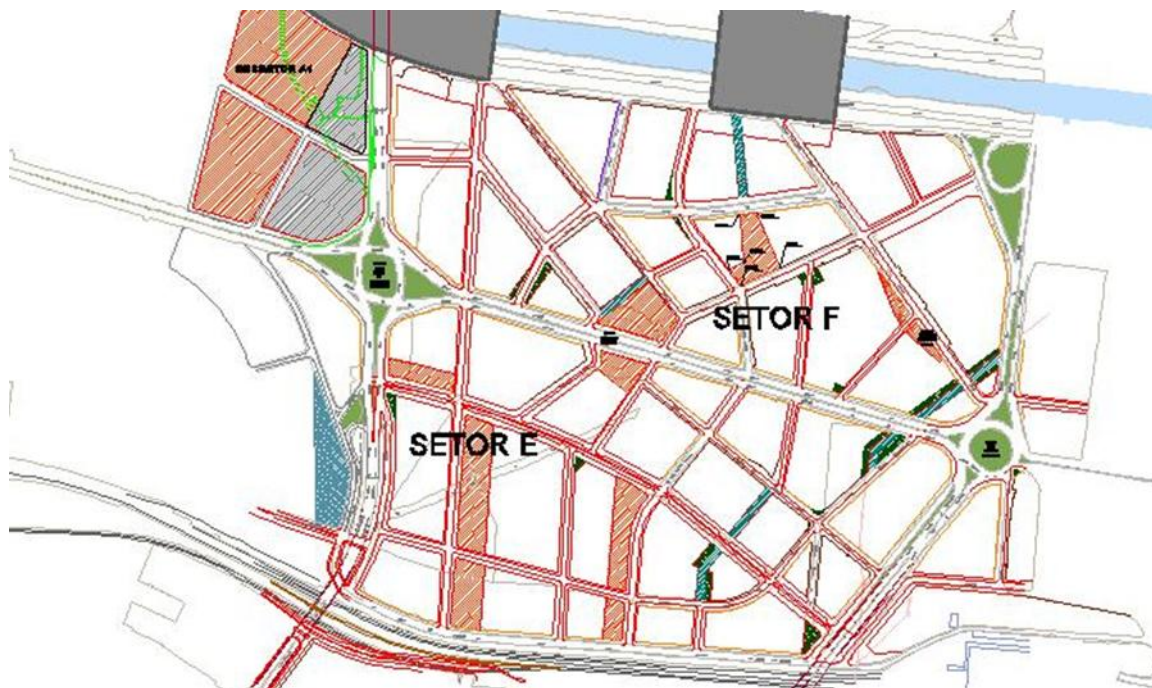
Setor E - Melhoramentos previstos
